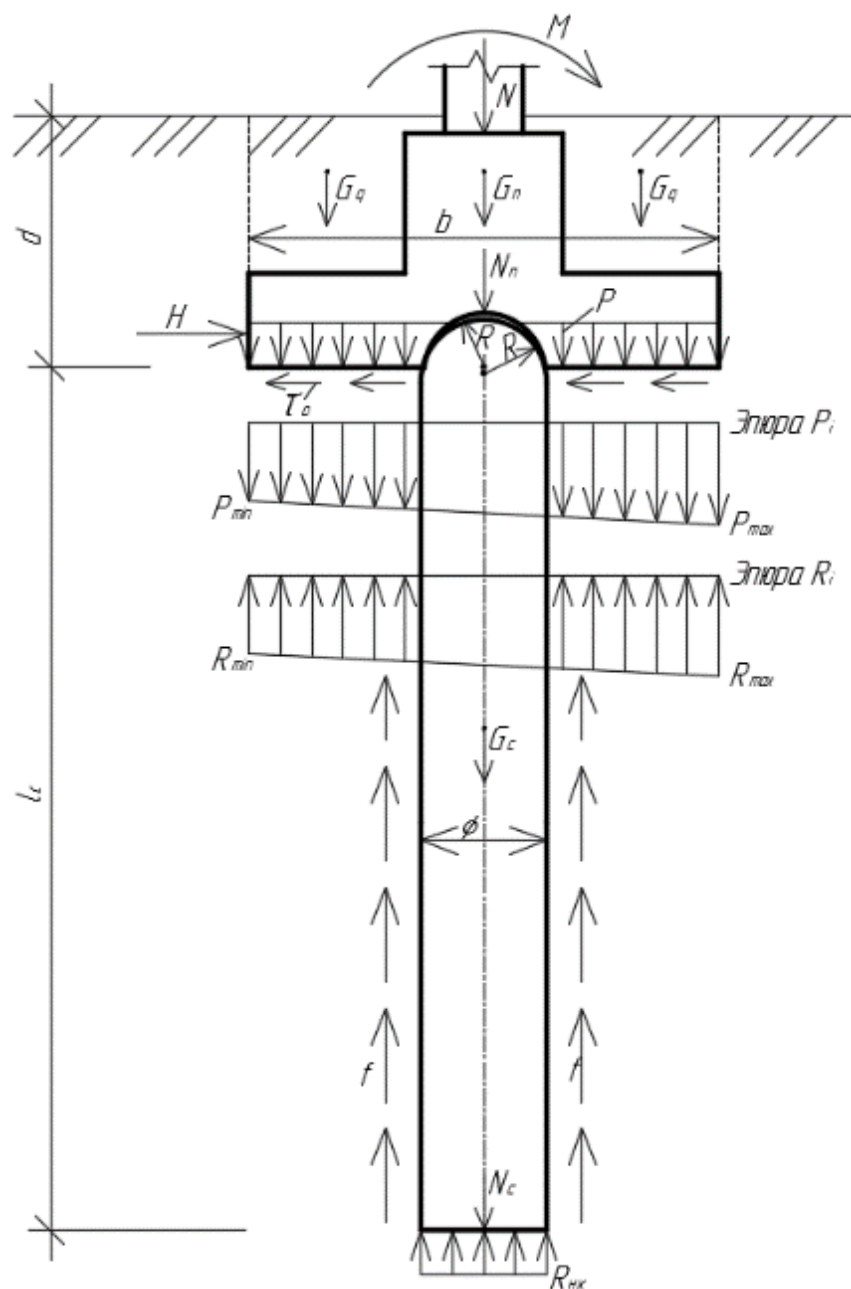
Силовая схема односвайно-плитного фундамента
